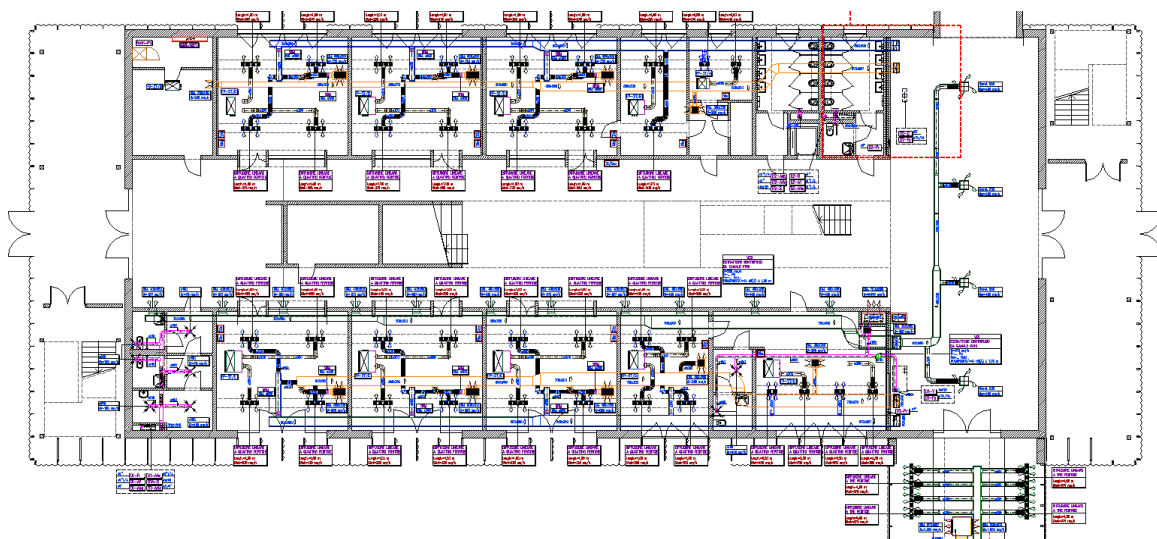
Pianta piano terra palestra: VMC in progetto
